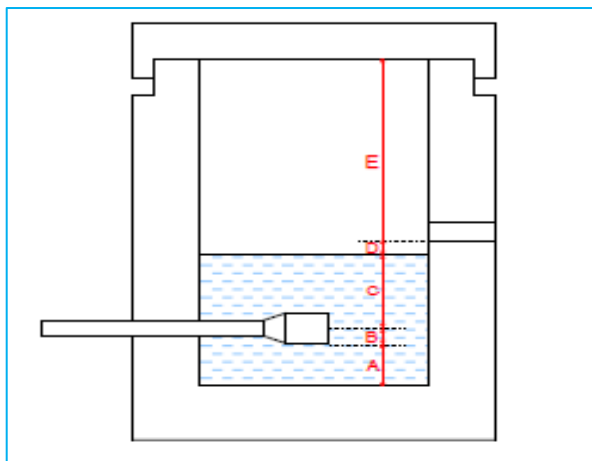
Cálculo de la cámara húmeda de una captación de ladera
